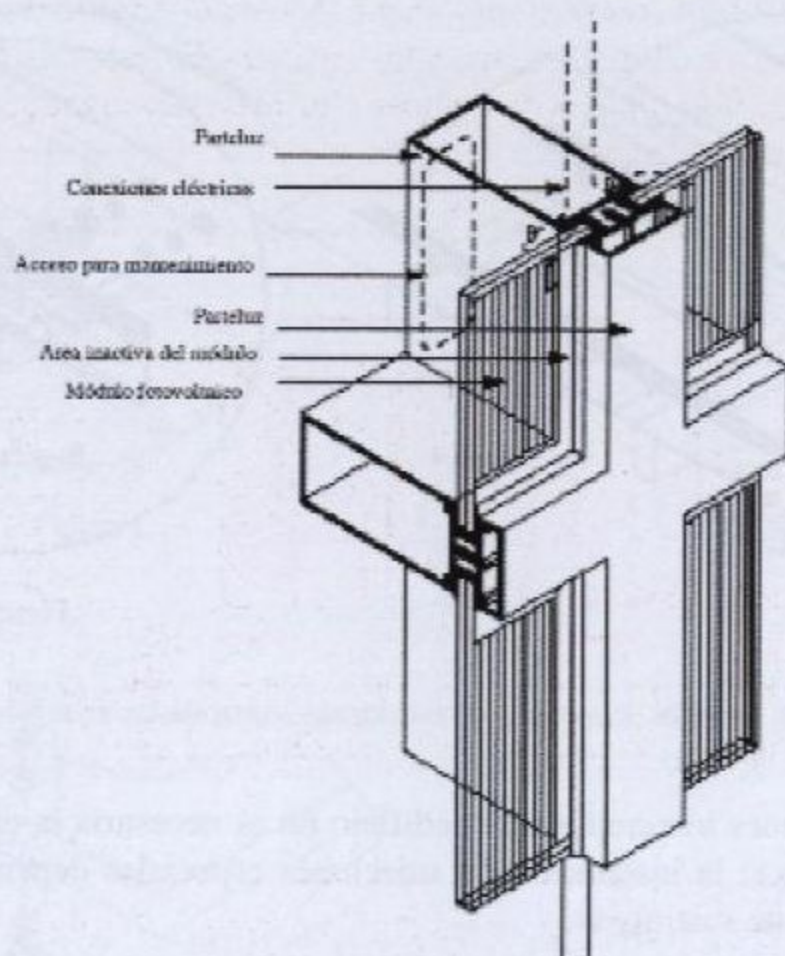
Detalle de instalación de estructura para instalación de módulos en fachadas
